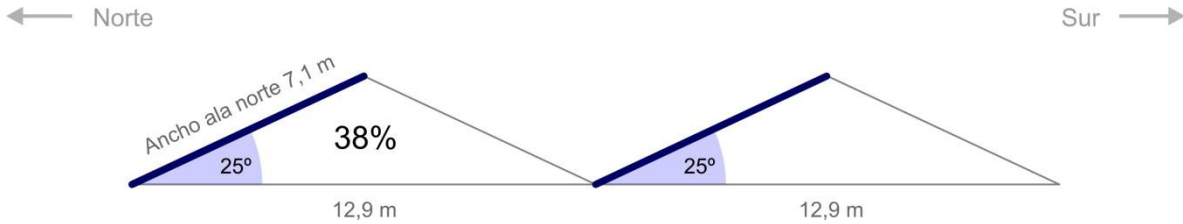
Ocupación máxima de cubierta en sección longitudinal de bloque este-oeste
